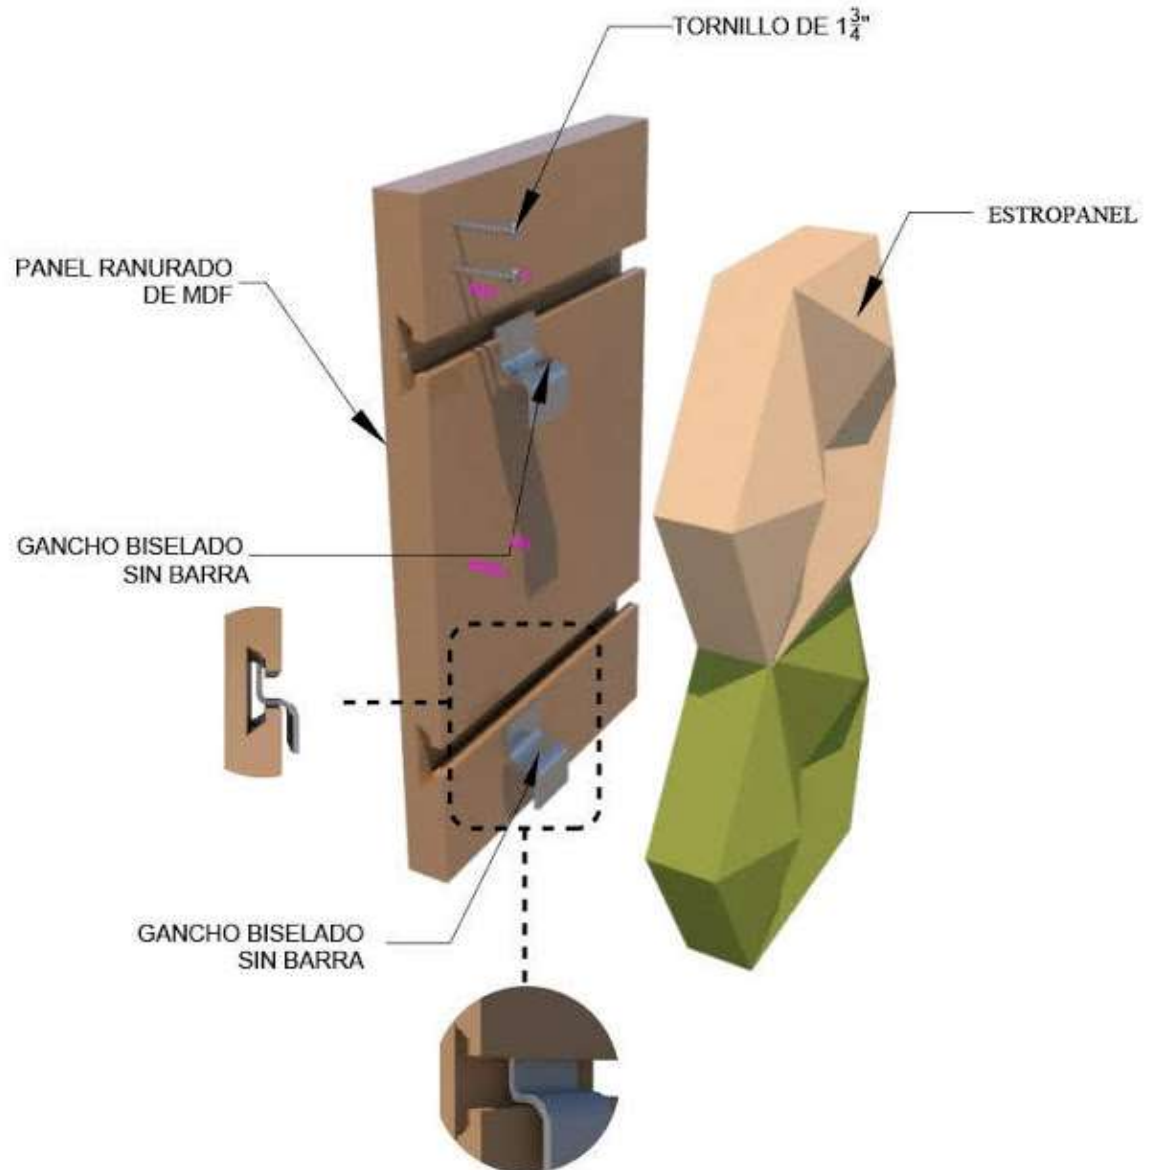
Detalle del sistema de instalación, soporte en madera ranurada y platinas en acero
